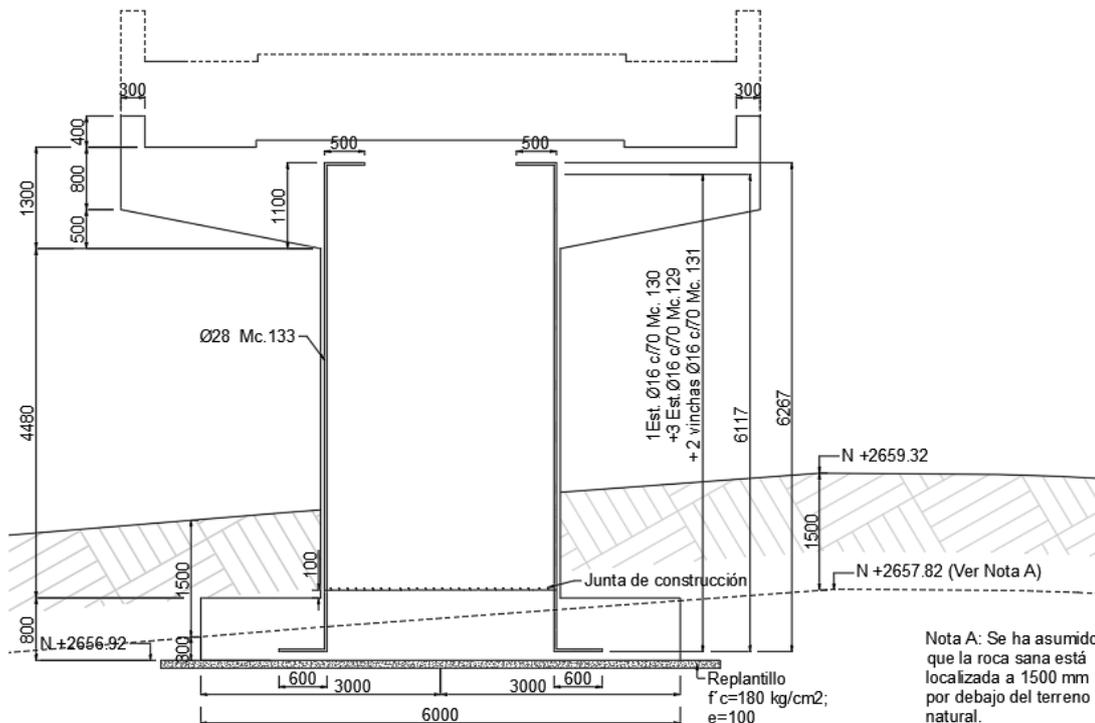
Armado pila 1 [Elaboración propia]
